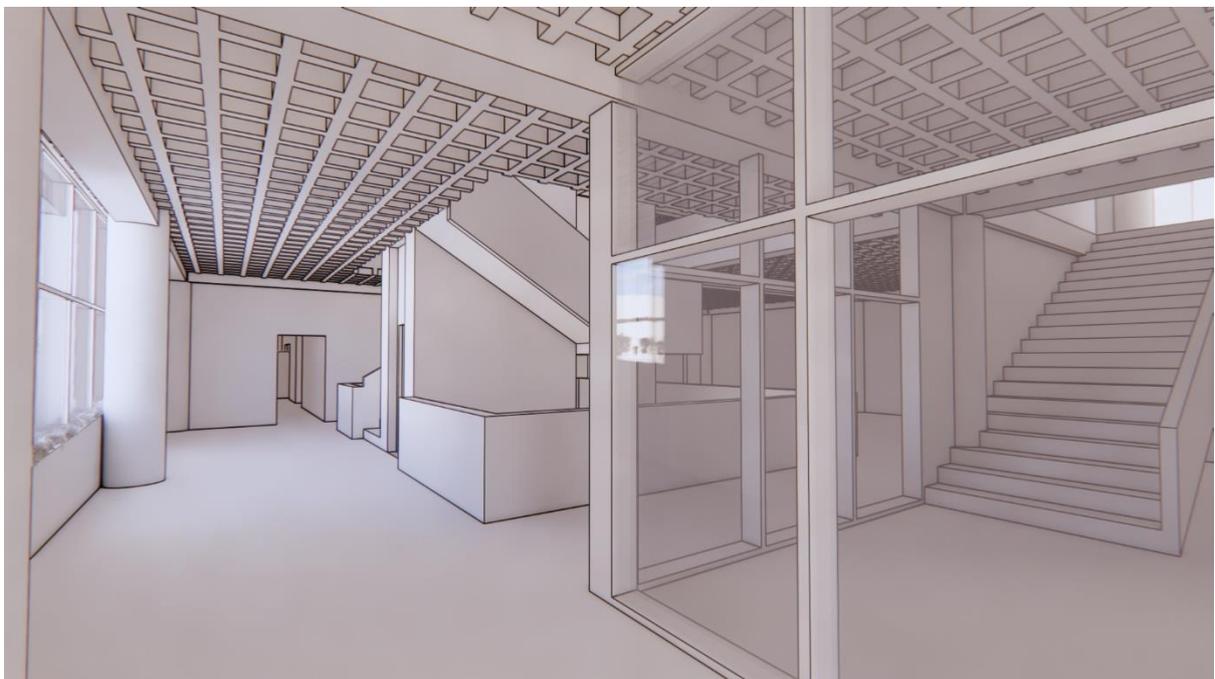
Vista Punto Fijo Secundario. Ilustración propia
